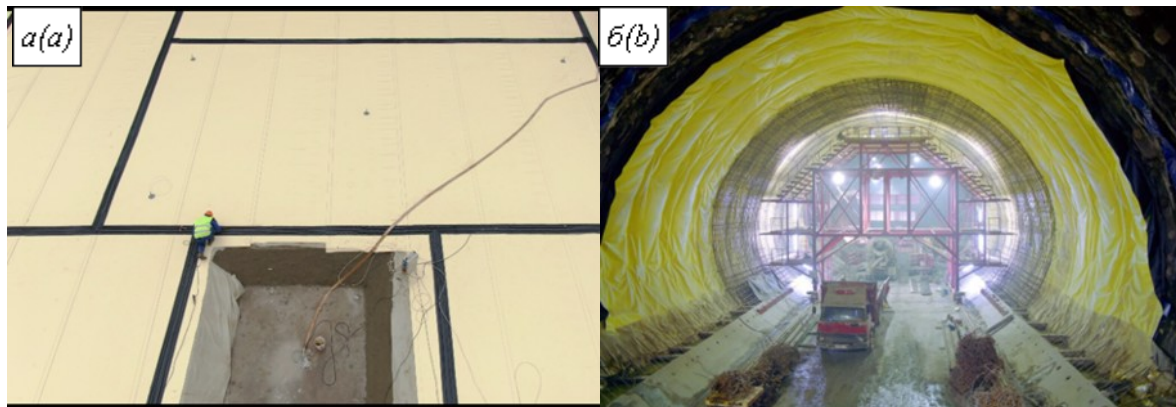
а – устройство однослойной ремонтпригодной системы гидроизоляции фундамента с ПВХ-мембраной и гидрошпонками; б – применение ПВХ-мембраны для гидроизоляции строящегося тоннеля метро
